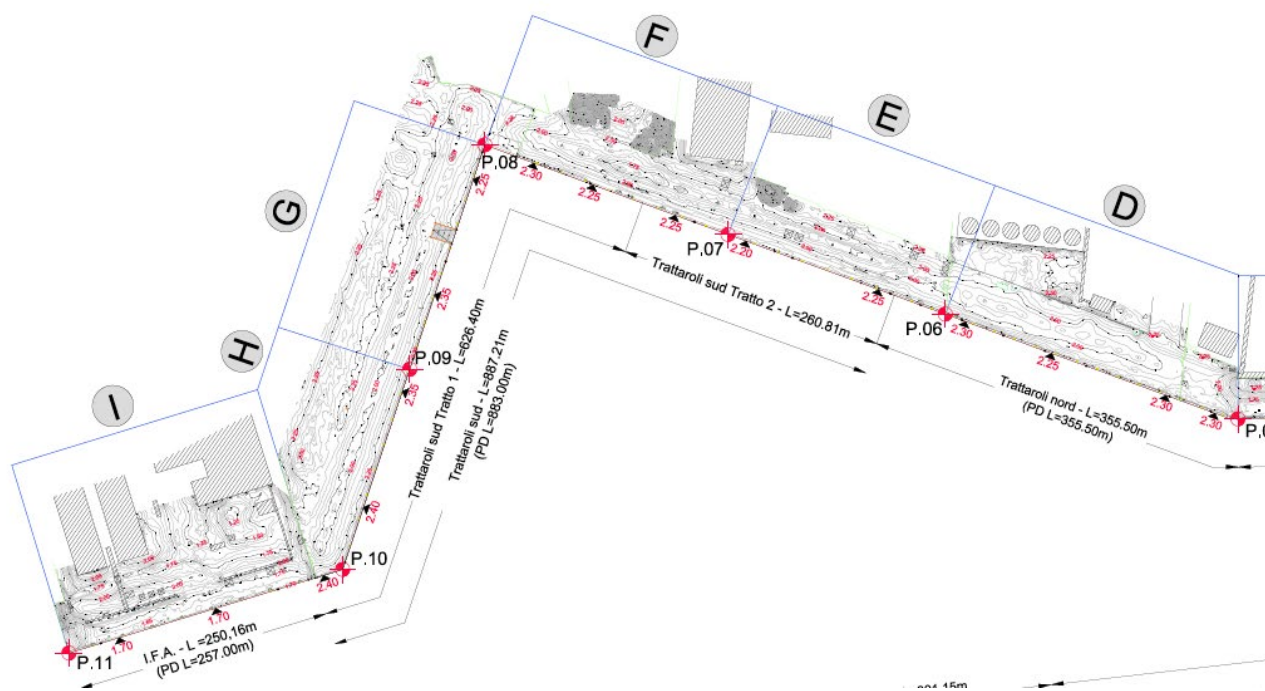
Stralcio 1 Planimetria inquadramento banchine
